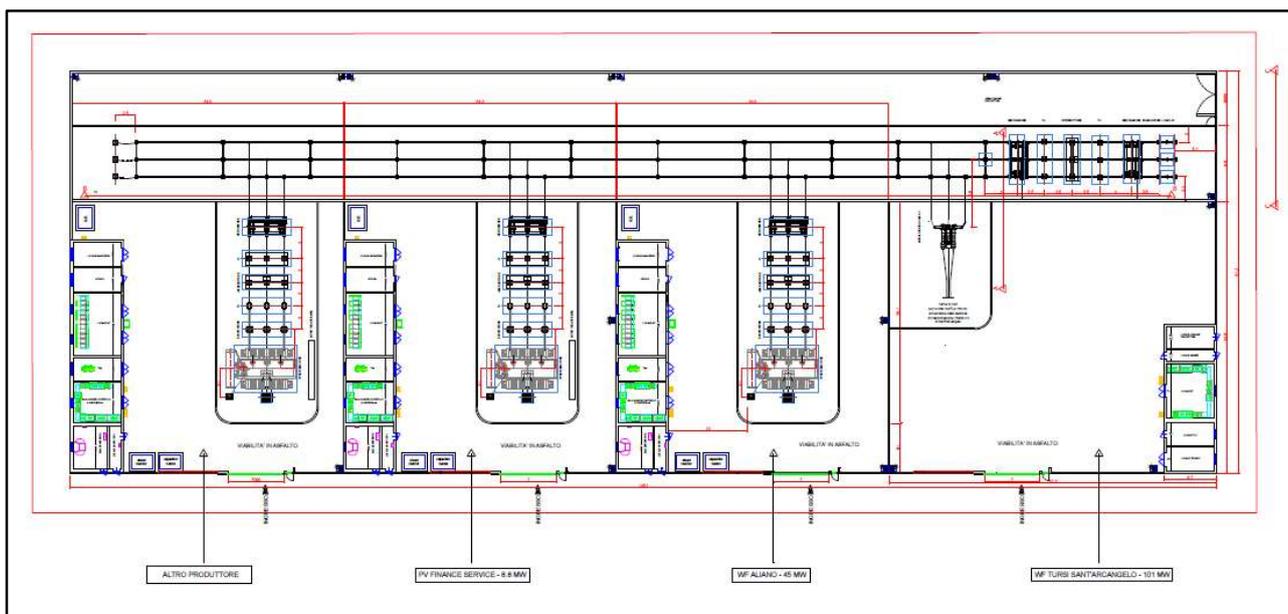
Planimetria elettromeccanica della Sottostazione elettrica condivisa
